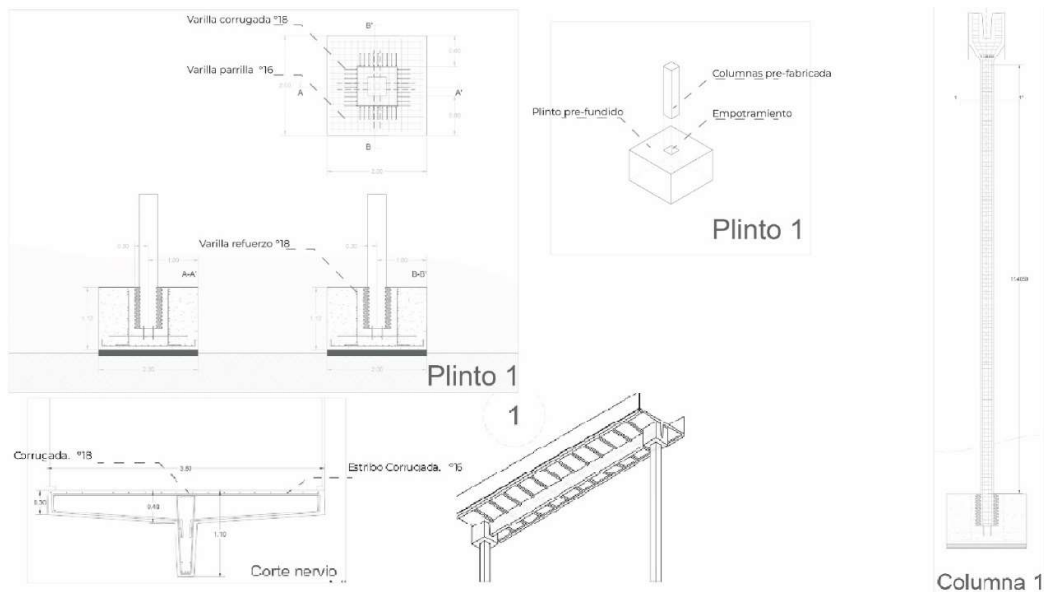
Detalle puente conector entre edificios, (Elaborado por Loján, 2020)
